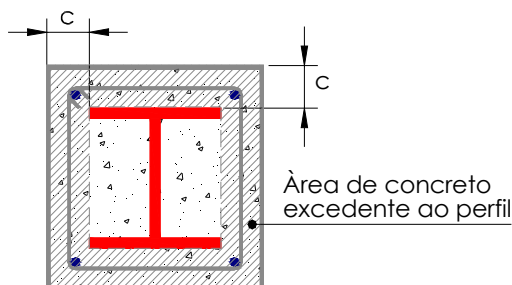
Seções transversais de pilares mistos – Cobrimento “ c ”.
